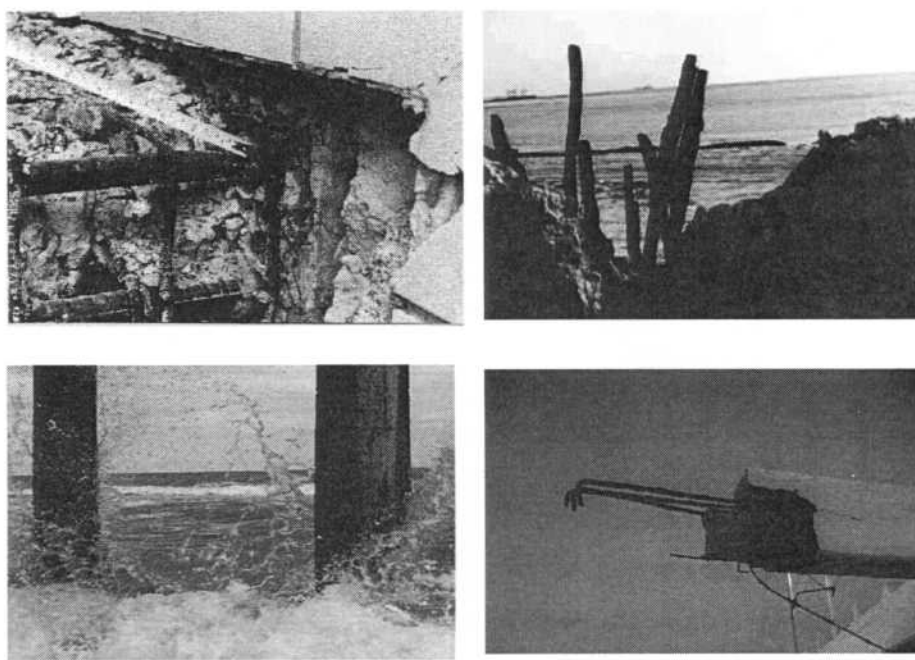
Efectos de la corrosión en las estructuras de hormigón armado.
